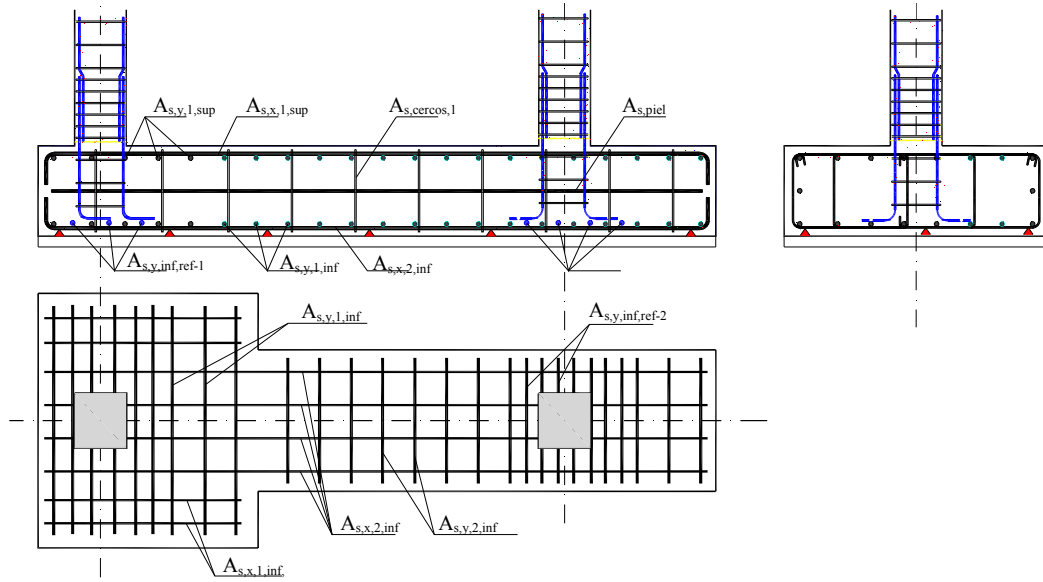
Modelo 4. Patrón de armado II. Con armado sup.
